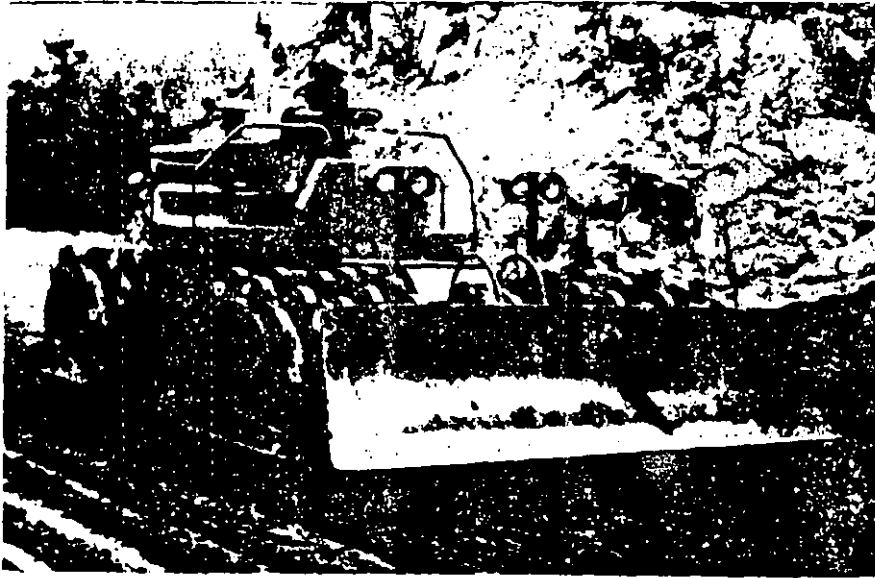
RODILLO DE IMPACTO (TAMPING - ROLLER)
